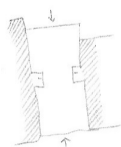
Boceto en planta de la geometría de la construcción situada en la Rúa Camilo Veiga, nº 42 (autoría propia).
